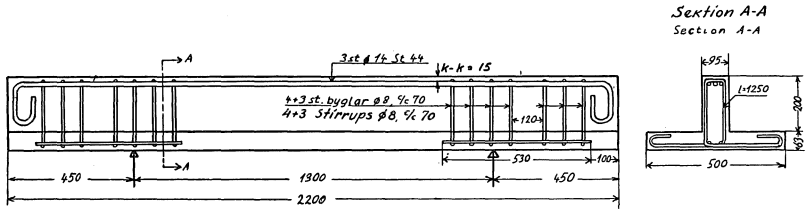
Dimensioner och armering hos provbalkar i serie V.
